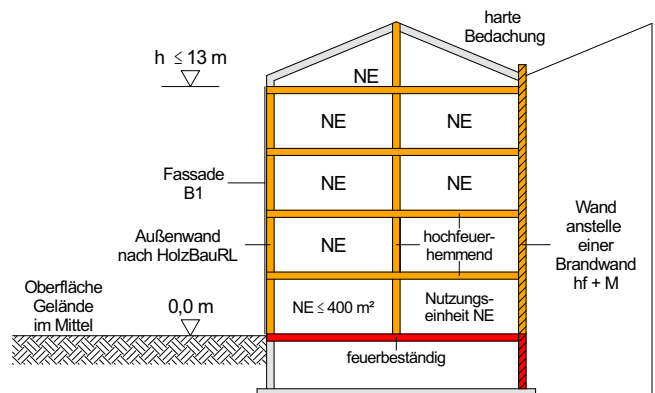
Brandschutzanforderungen nach HolzBauRL in der Gebäudeklasse 4
